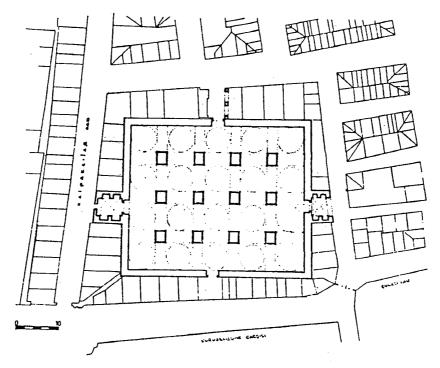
مسقط أفقى لبادستان أدرنه (عن : Cezar) .
